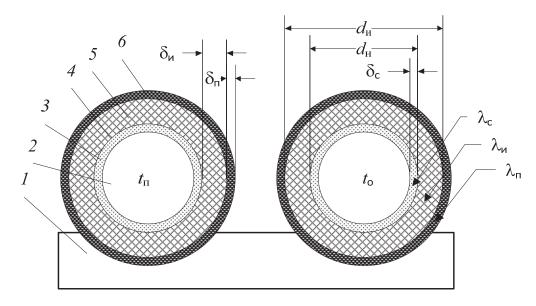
Схема двухтрубной теплоизолированной конструкции теплопровода надземной прокладки: I- опора; 2- теплоноситель; 3- стенка трубопровода; 4- антикоррозионное покрытие; 5- основной слой тепловой изоляции; 6- слой гидроизоляционного покрытия
